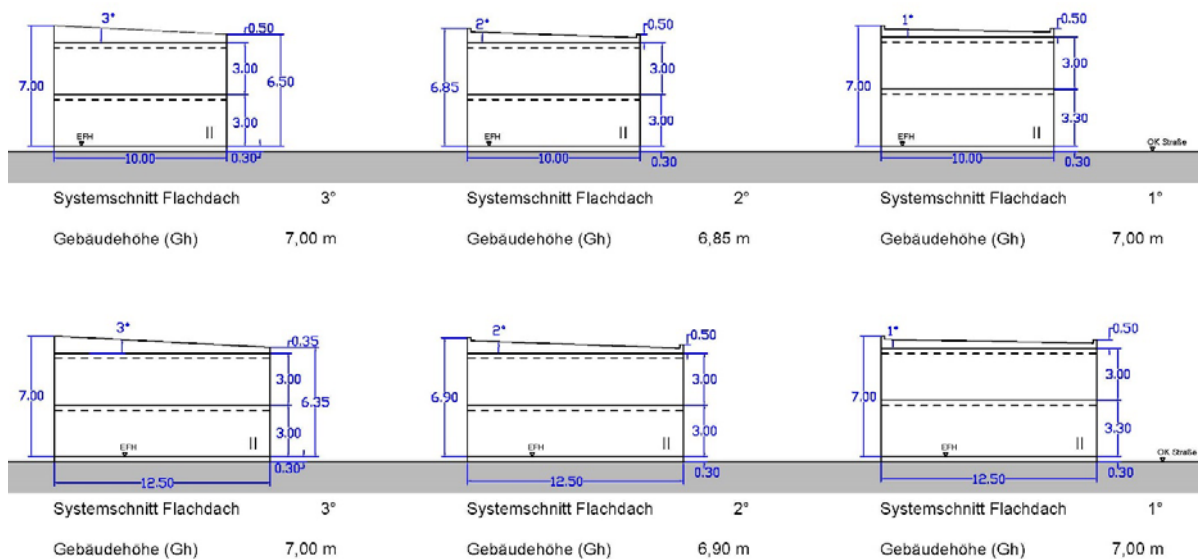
Systemschnitte Gebäude mit Flachdach. (Gh 7,0 m, DN 0 - 8°), Stand 17.08.2015, ohne Maßstab
